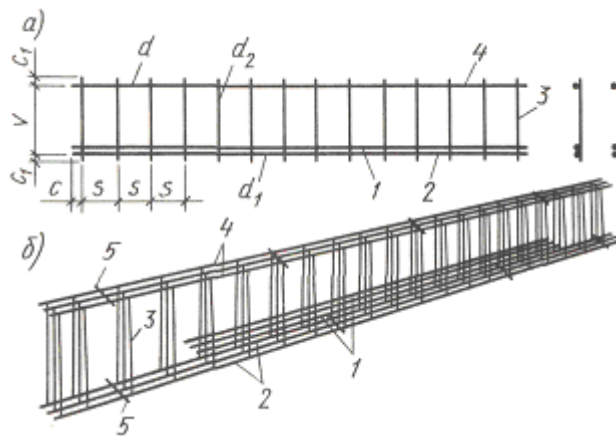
Типи арматурних каркасів: а – плоский; б – просторовий; 1 – другий ряд робочої арматури; 2 – нижній ряд робочої арматури; 3 – хомути; 4 – монтажні стрижні; 5 – монтажні (з'єднувальні) стрижні
